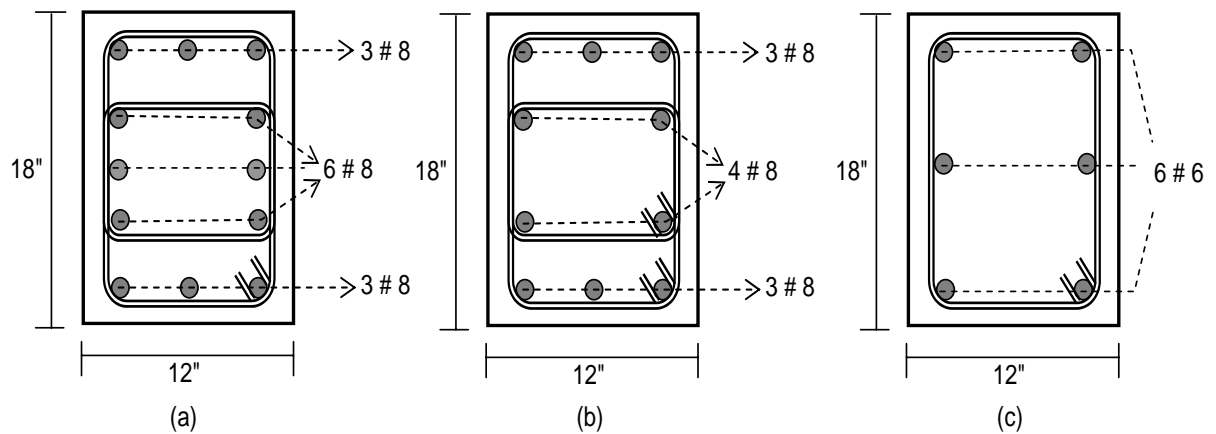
Distribución de acero longitudinal en secciones de columna halladas en escuelas.
